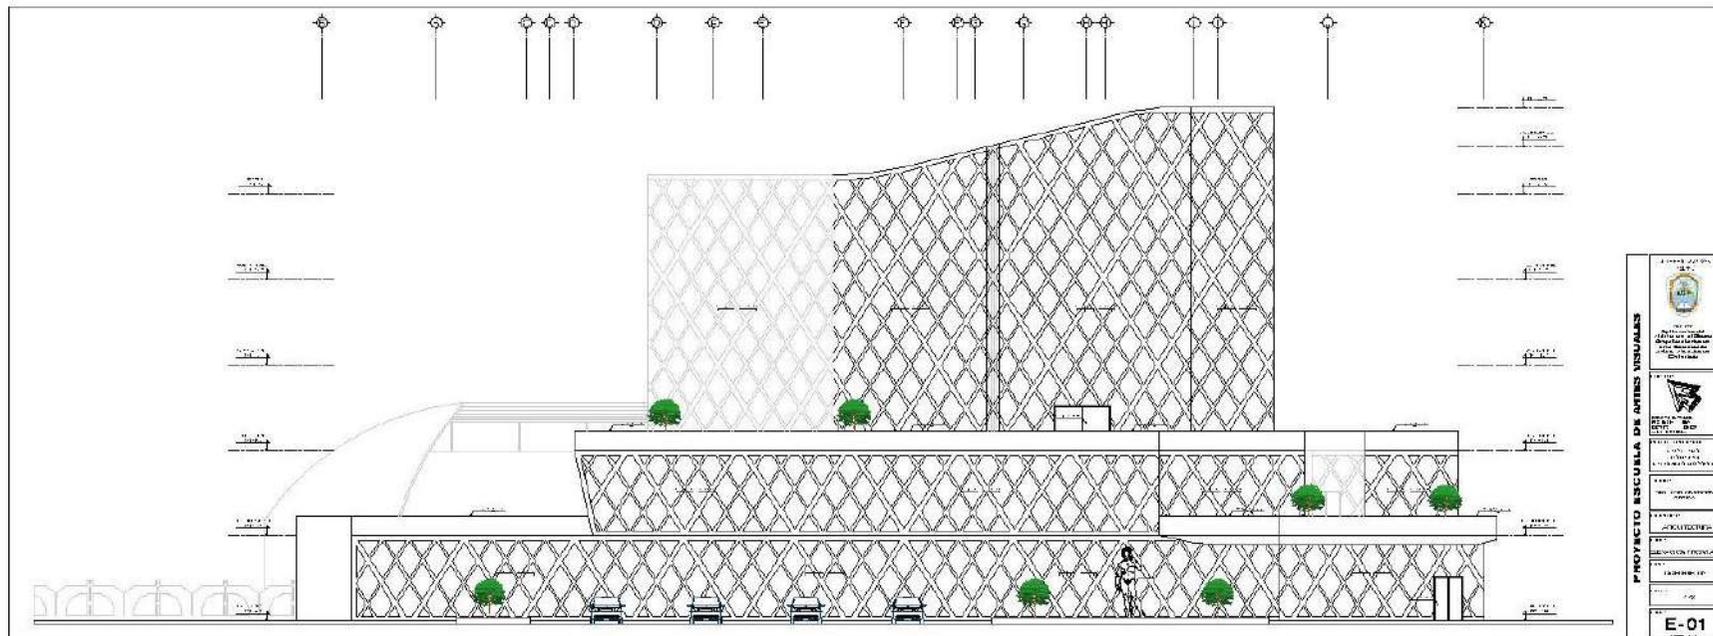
Plano de Corte E-E del Proyecto Arquitectónico
